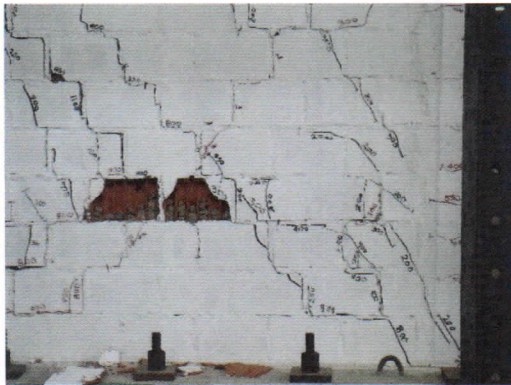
Levantamiento del ladrillo al lado Este del ladrillo de la foto anterior en la cara Sur para una distorsión de 1/200 en el 1° ciclo.
